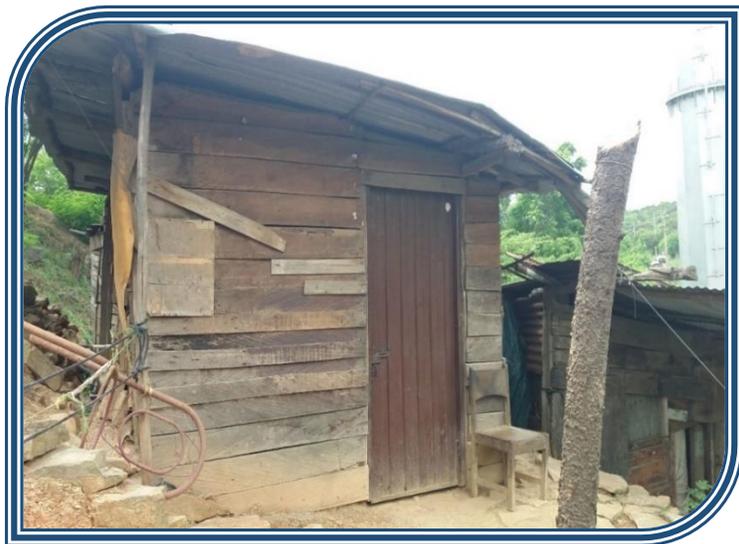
Edificación tipo del Barrio Virgilio Barco Parte Baja.
